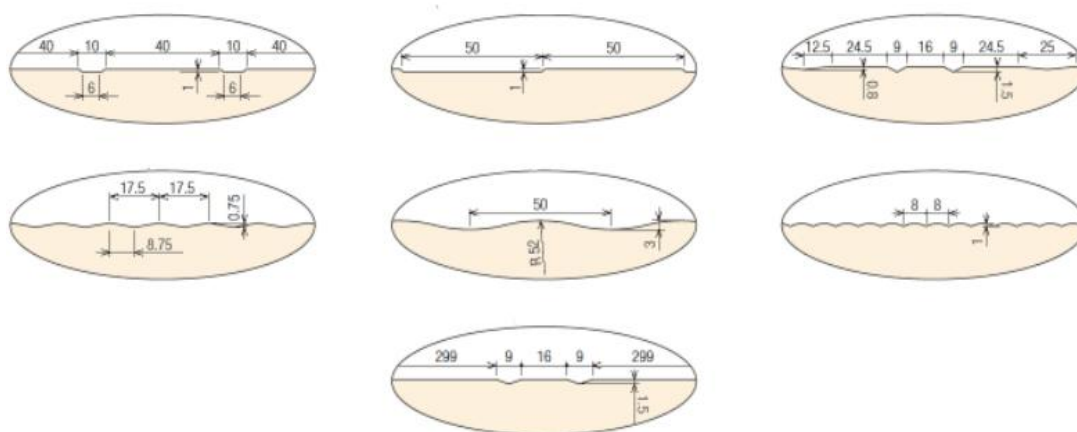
Dimensões e perfis característicos da chapa exterior. Adaptado de [84].
